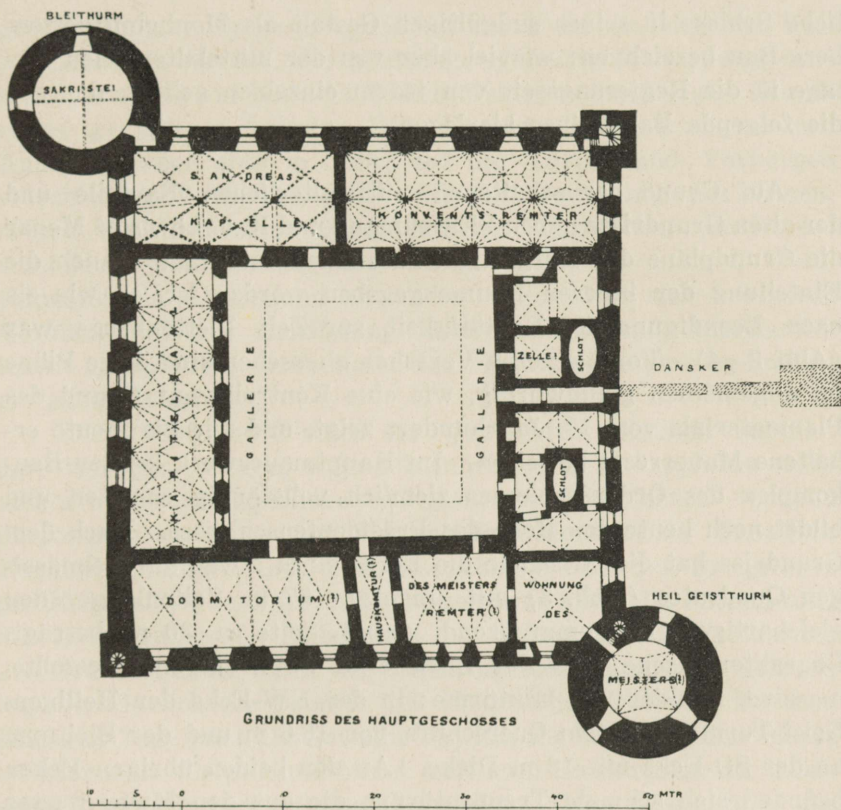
Grundriss des zweiten Stockwerks des Schlosses. Nach Neumann.
